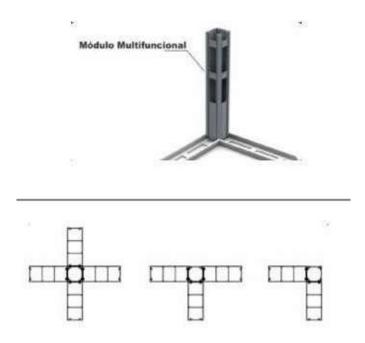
Esquema do perfil multifuncional, posicionado no encontro entre paredes (planta)
